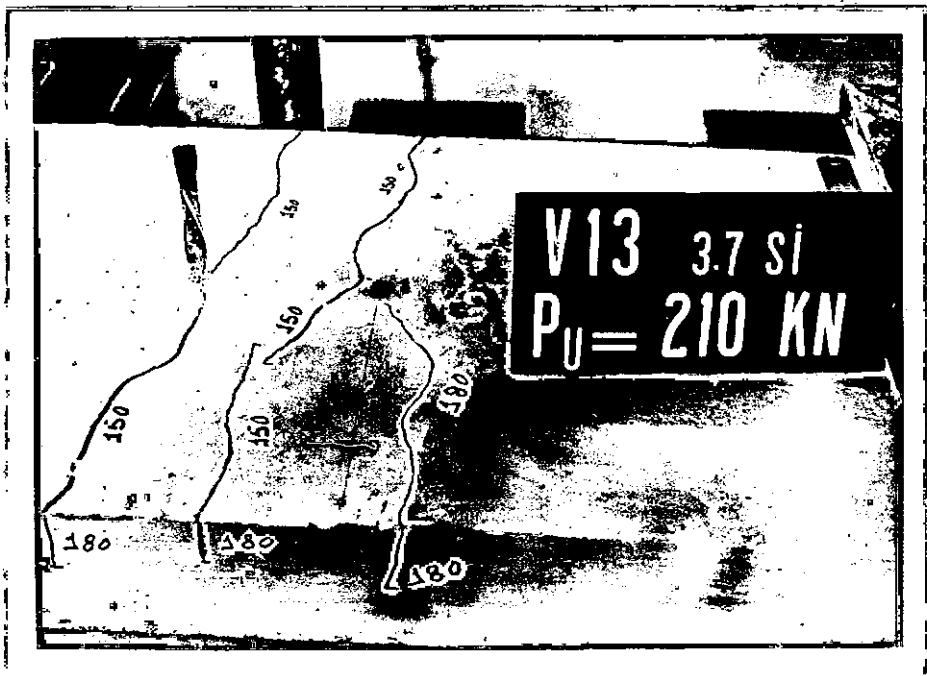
Fissuração na mesa superior da V13-3,70-SI
